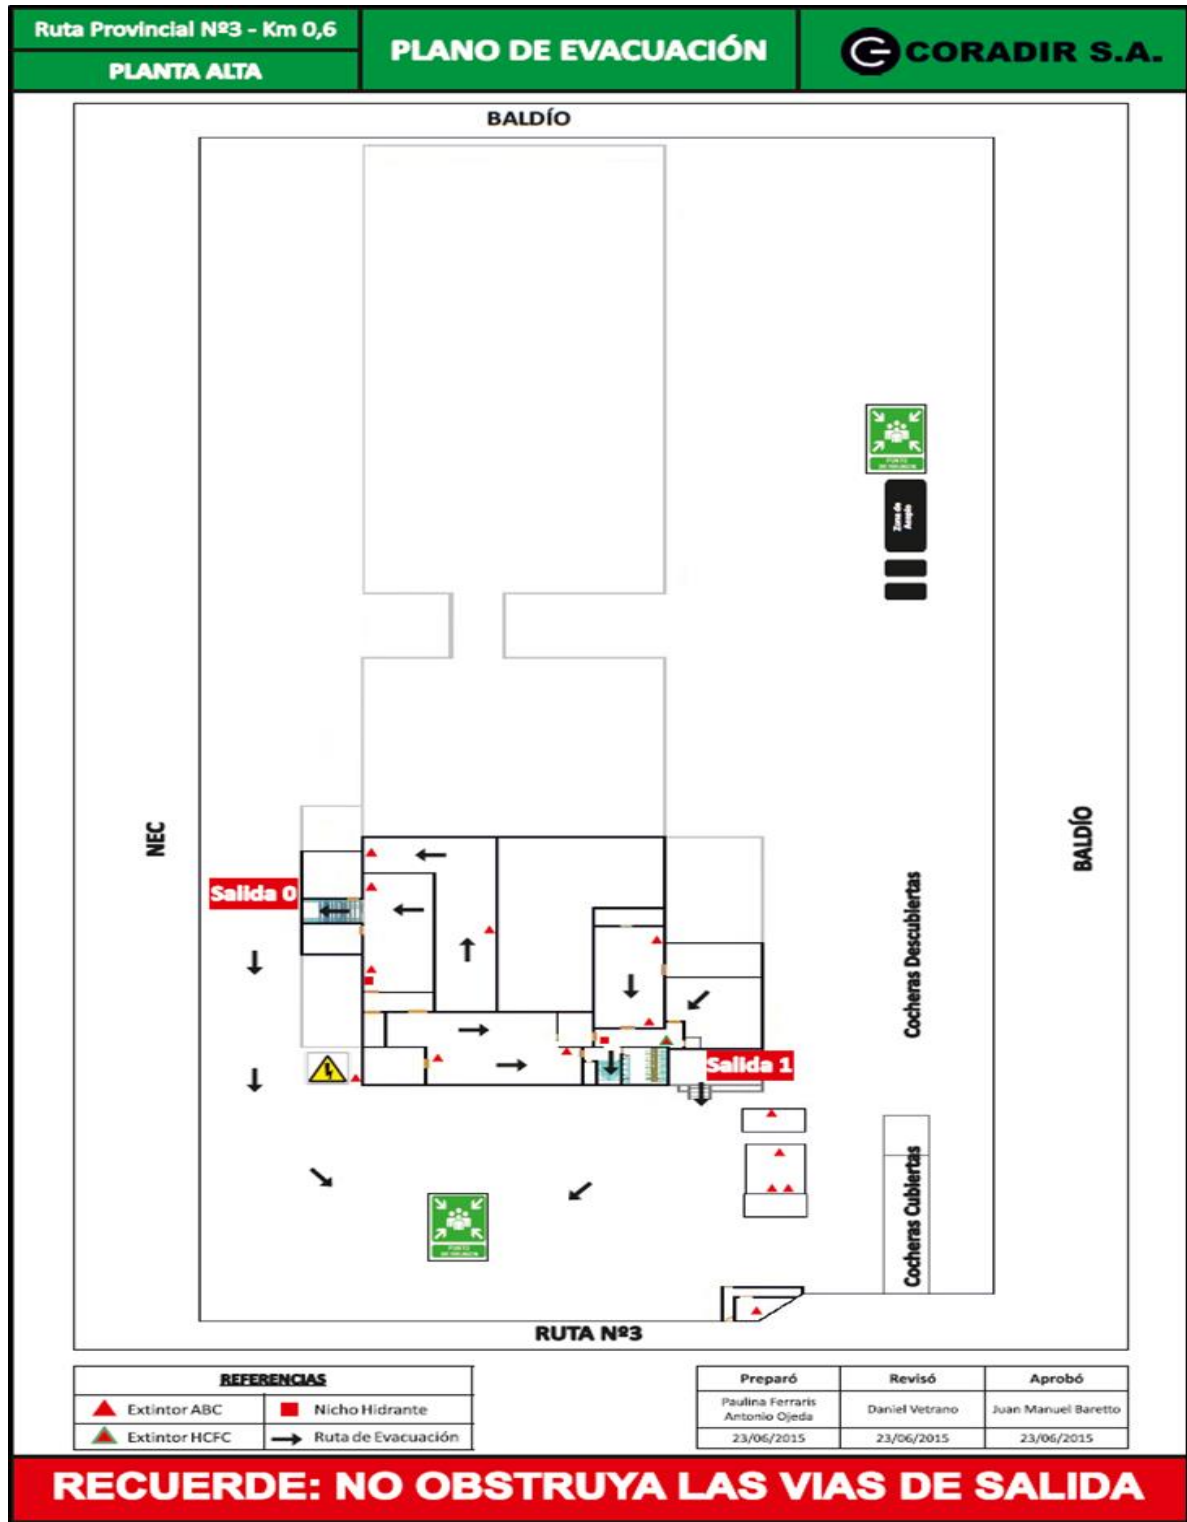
Planos de evacuación, extintores y nichos hidrantes planta alta.
